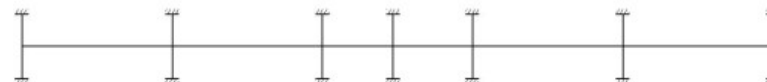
Расчетная схема плоской рамы с жестким соединением колонн и диска перекрытия.
